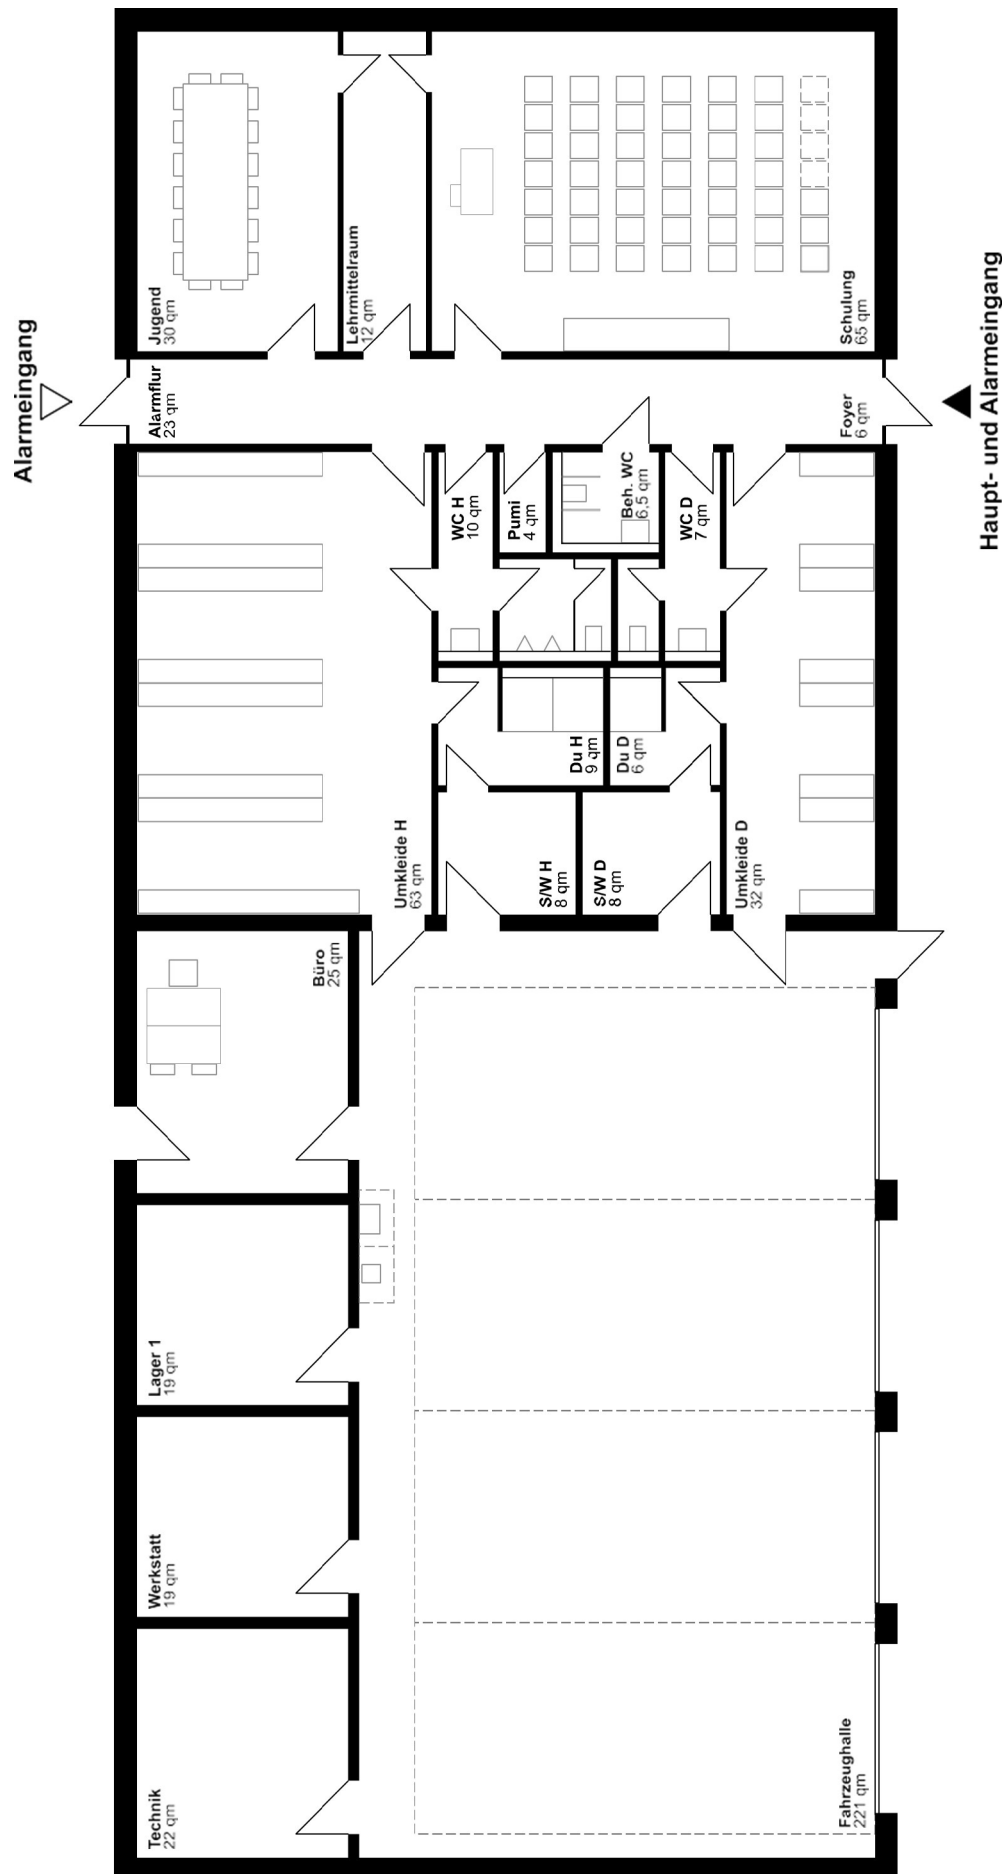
Musterraumprogramm 4 Stellplätze eingeschossig, Grundrissplan
